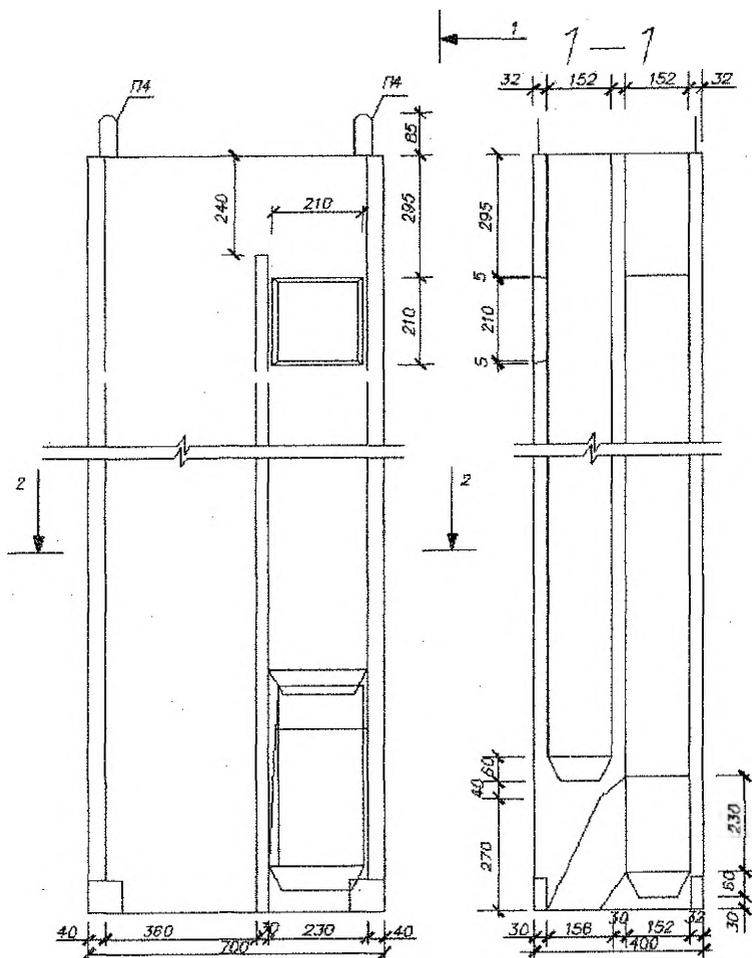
Размеры унифицированных железобетонных вентиляционных блоков серии Б1.134.1
